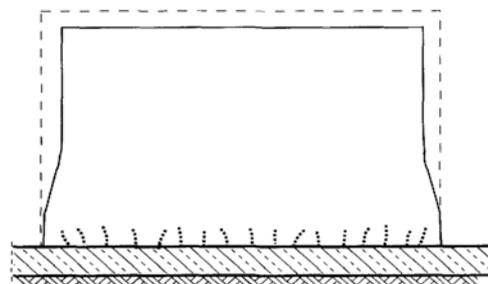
Bodenplatte mit nachträglich betonierter Wand
